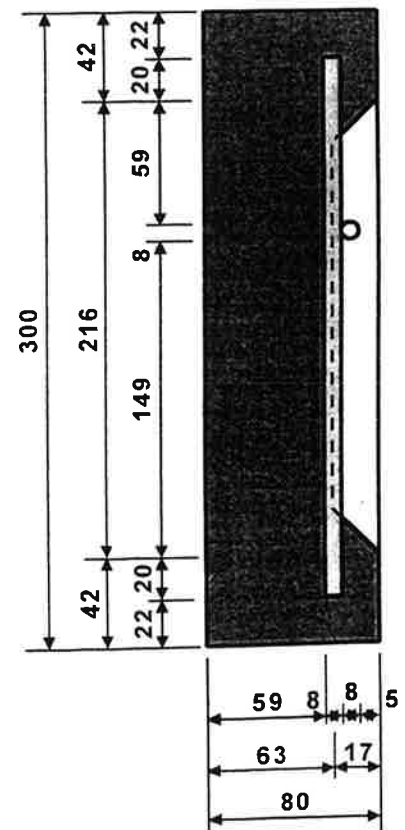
Reprofilierungsplatten-Grundkörper für Prüfungen nach Abschnitten 2.7.11, 3.6.4.9 und 4.6.9
